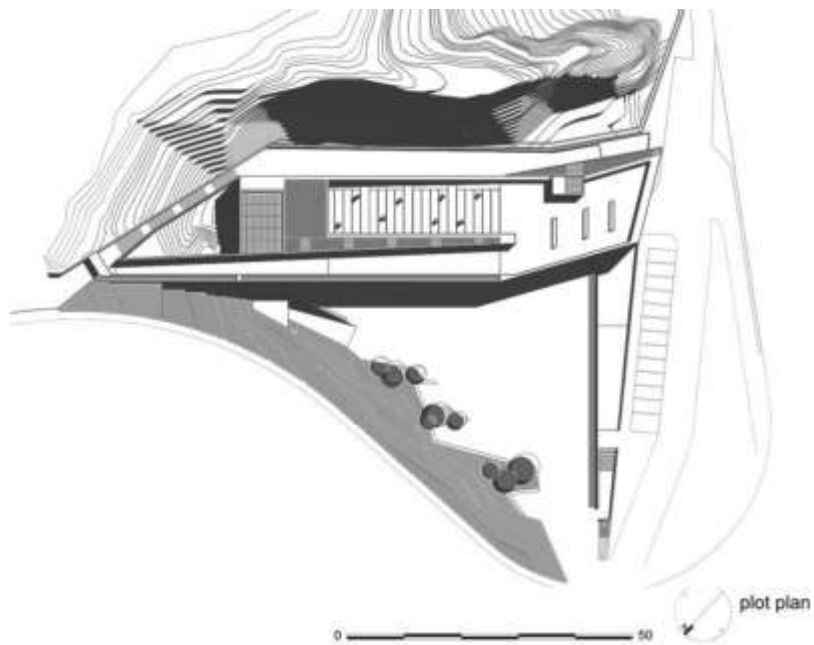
LUM. Planta del techo con sombras. Estudio Barclay & Crousse
